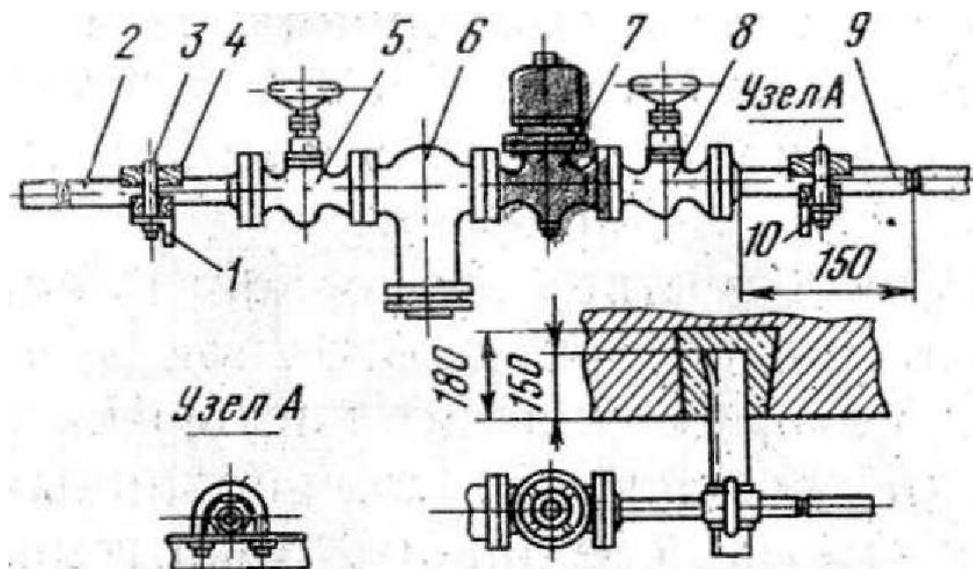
Узел монтажа СВМ соленоидного вентиля трубопровода:
